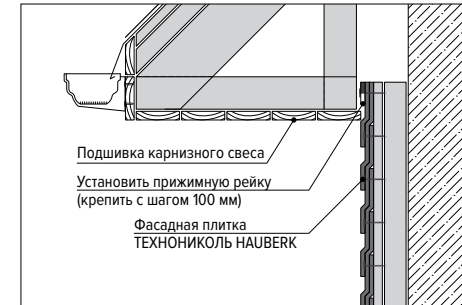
Монтаж верхнего ряда под карнизным свесом
